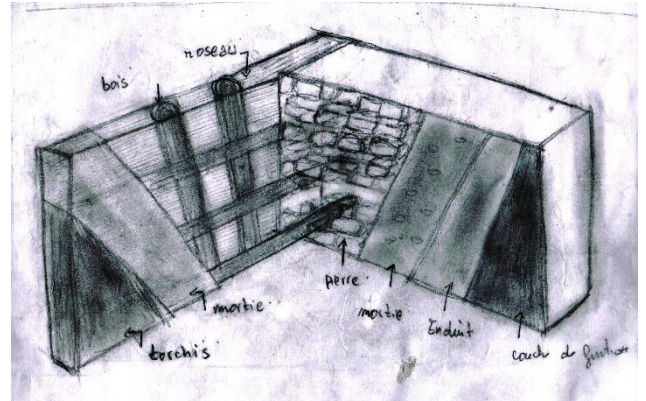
assemblage du mur en pierre et mur en (bois-rousseau)
